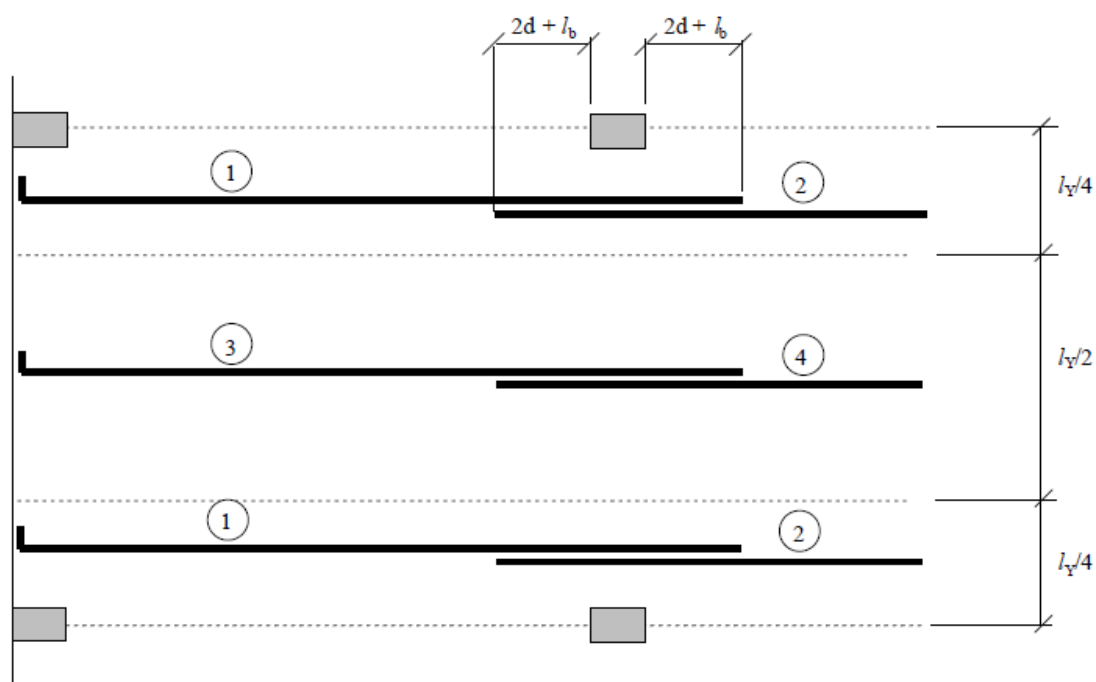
Armaduras inferiores simplificadas (LONGO, 2008).
